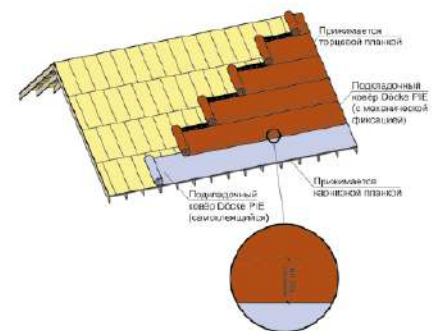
Схема расположения подкладочного ковра Döcke (последовательность укладки полотен в соответствии с пунктом 4.1.6).
